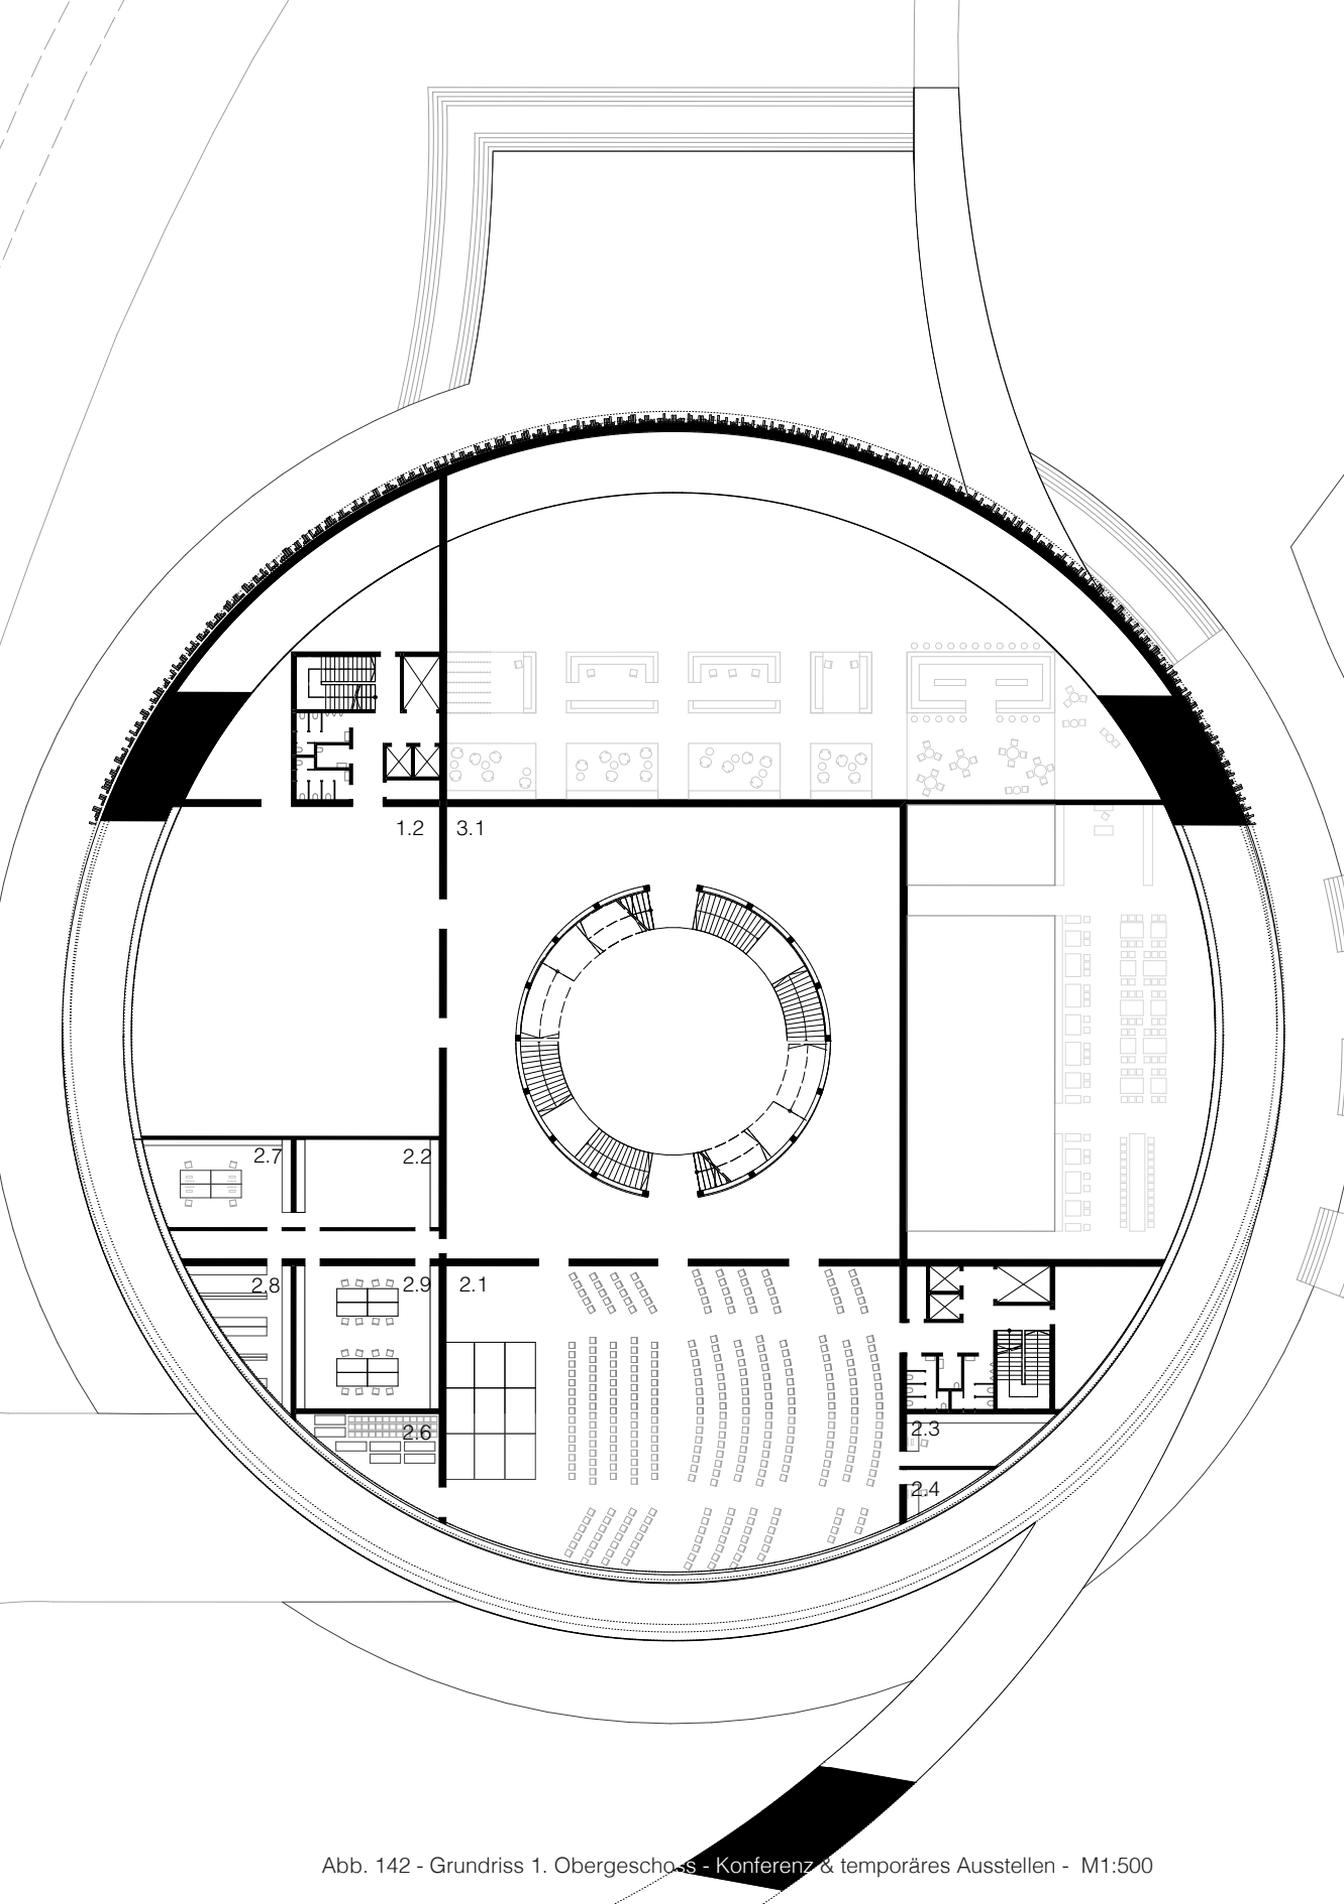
Grundriss 1. Obergeschoss - Konferenz & temporäres Ausstellen - M1:500
